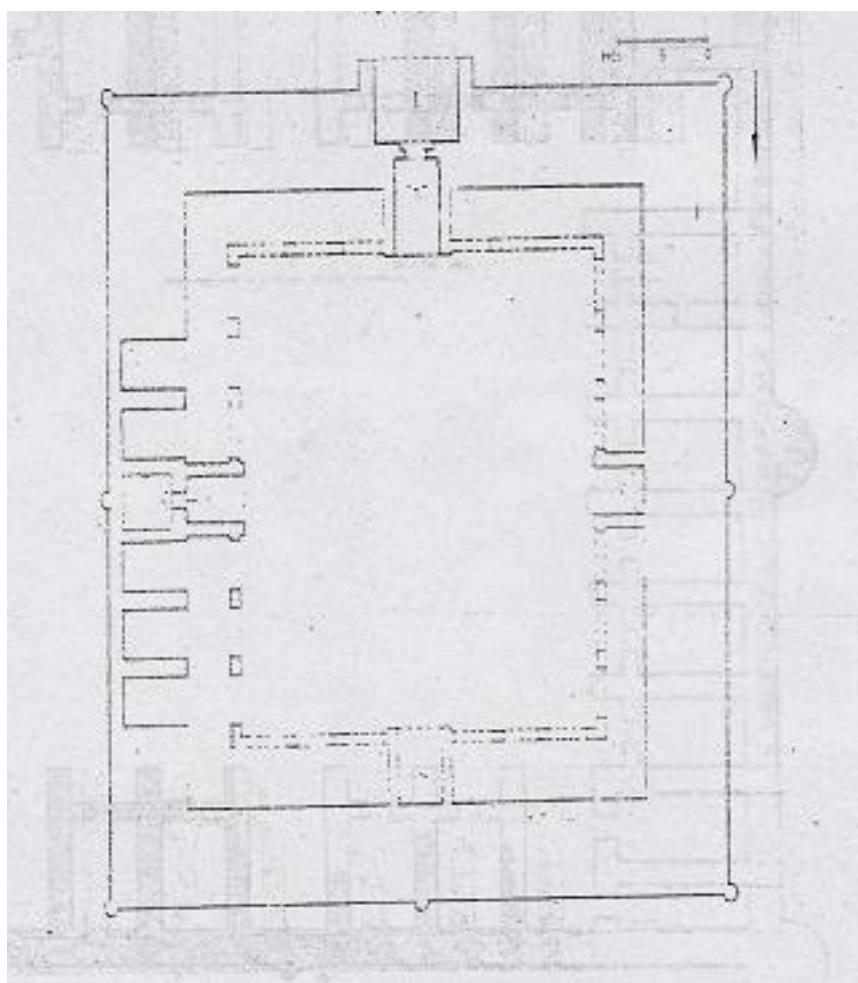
مسقط افقي لخان لرباط شرف طريق سرخس - خراسان -
